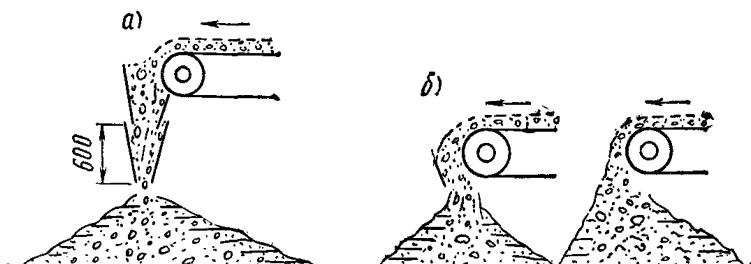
Схема разгрузки бетонной смеси с конца транспортера
